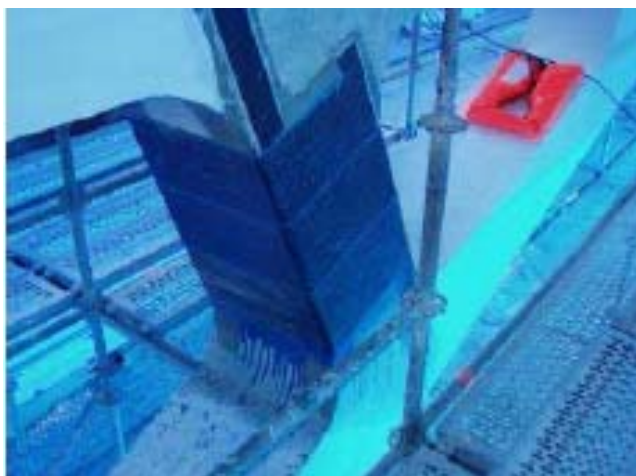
reforço com CFRP em elementos inclinados da ponte sobre o Rio Cávado
